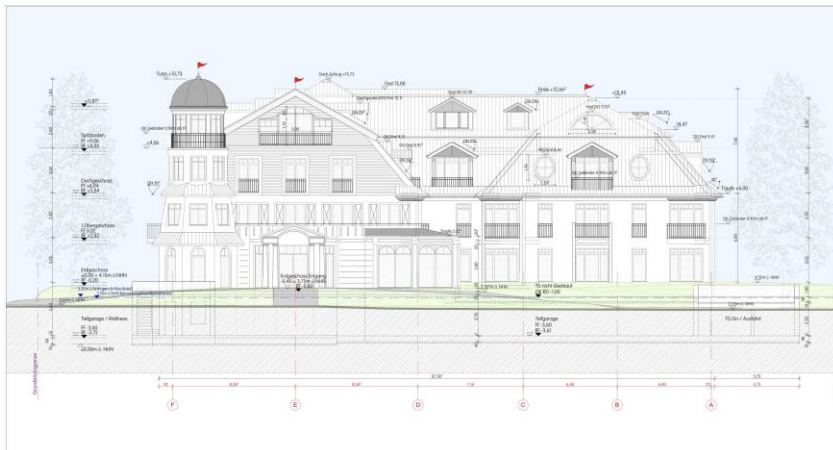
Ansicht von Nordosten. Baltischer Hof, Suitenhotel in Boltenhagen. Architekt: Planungsgruppe Gieseke, Kühlungsborn und Pohl Architektur, Berlin. Stand 18.08.2017
